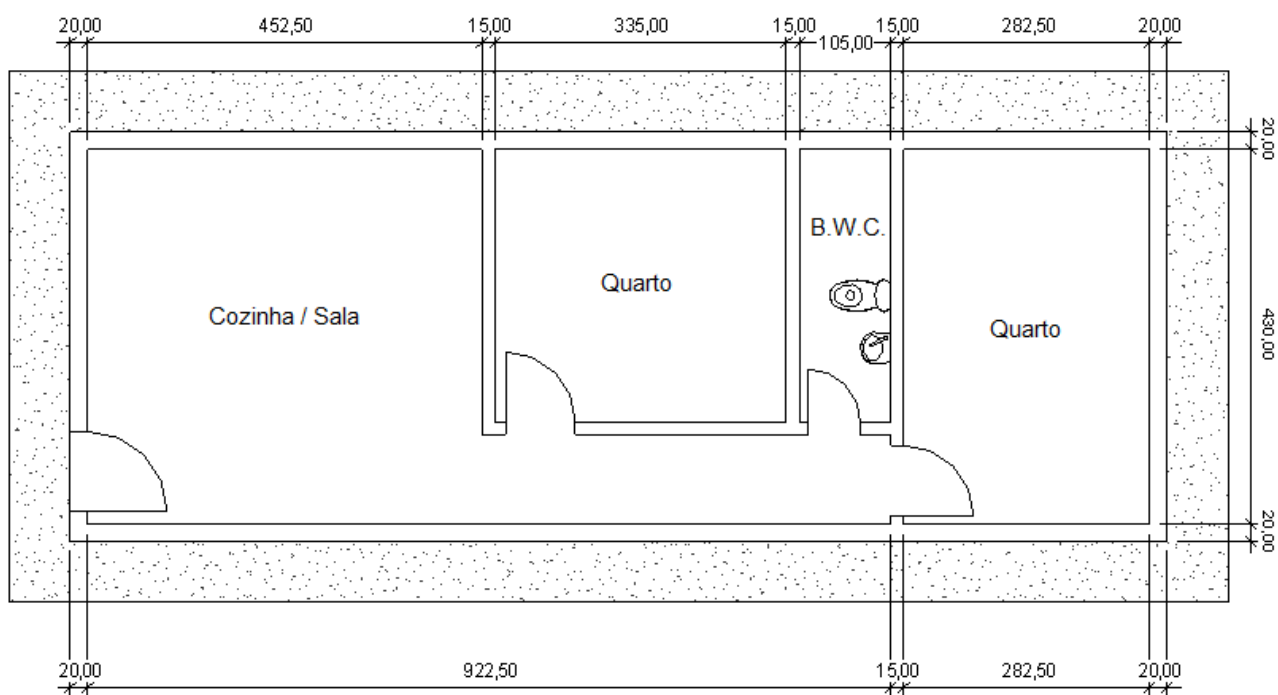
Planta baixa do modelo Fonte: elaborado pelos autores.
